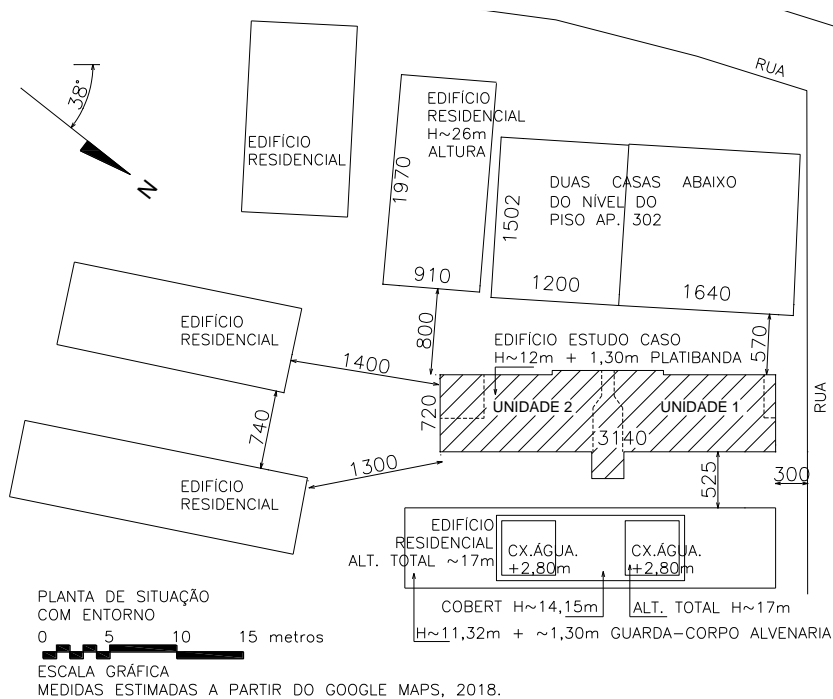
desenho em AutoCAD 2D, indicando a planta de situação.
